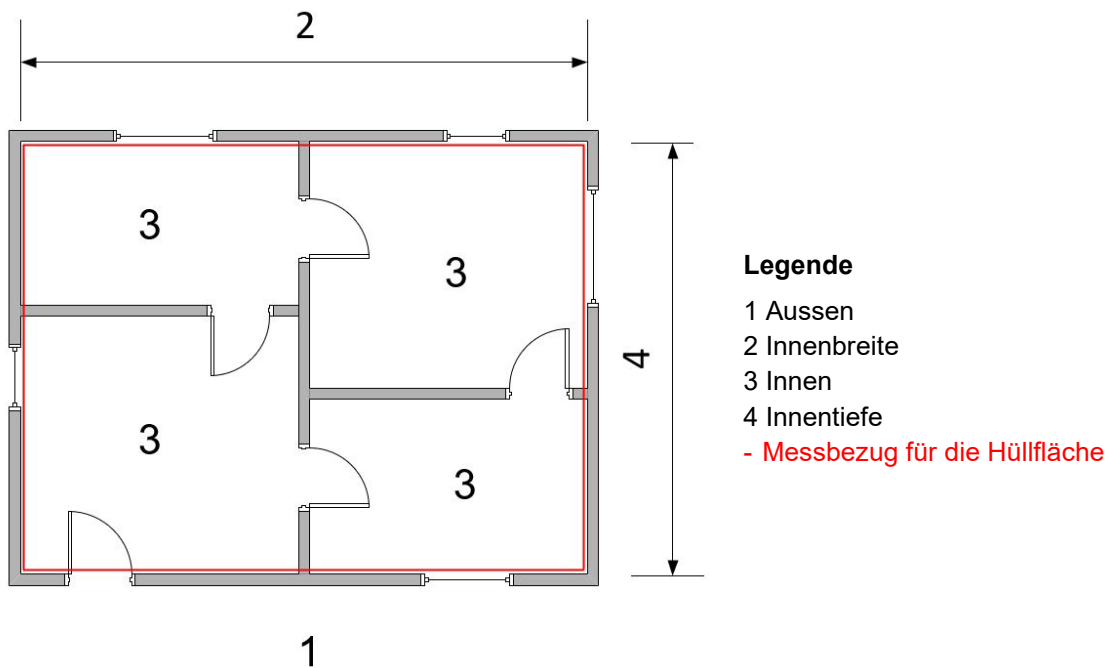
Grundriss mit Darstellung der Gesamt-Innenabmessungen (Quelle: SN EN ISO 9972; 2015 [2])
